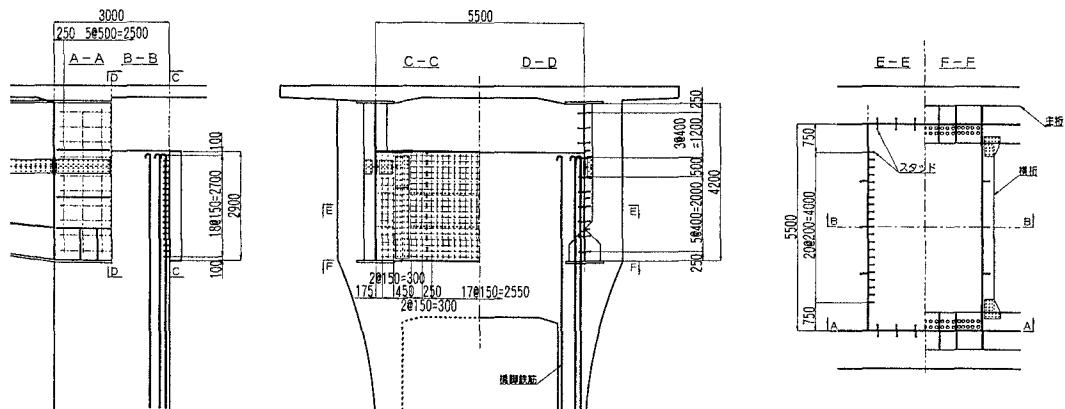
鋼桁と鉄筋コンクリート橋脚剛結部の構造詳細
